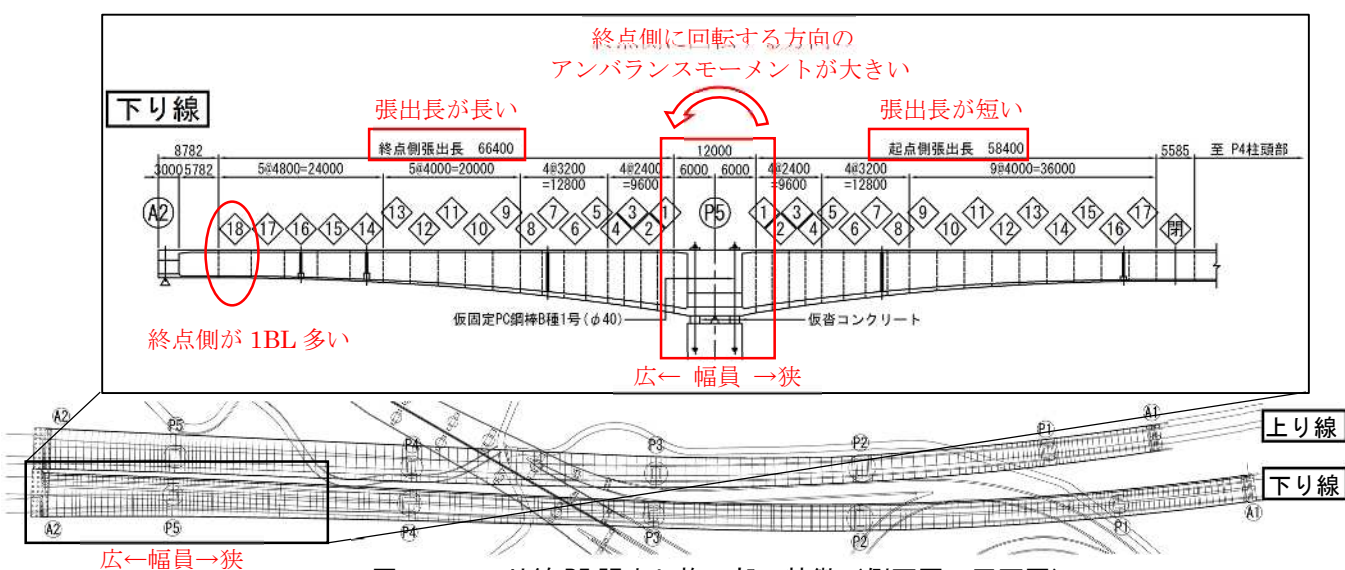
下り線 P5 張出し施工部の特徴（側面図，平面図）
